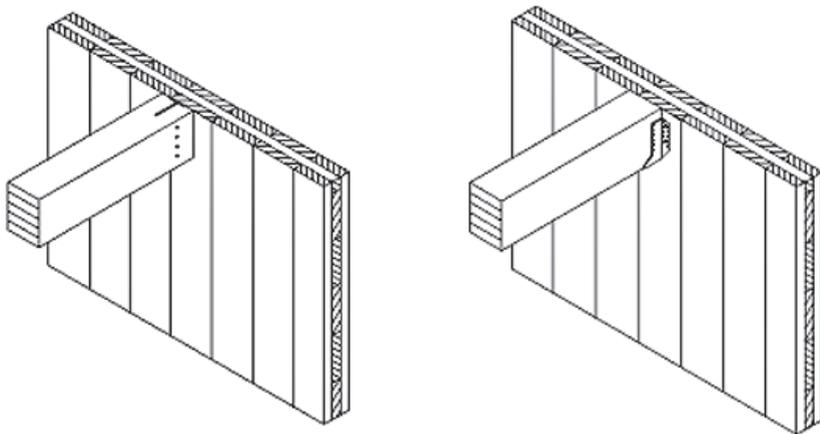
Collegamento di una trave alla parete mediante staffe metalliche
